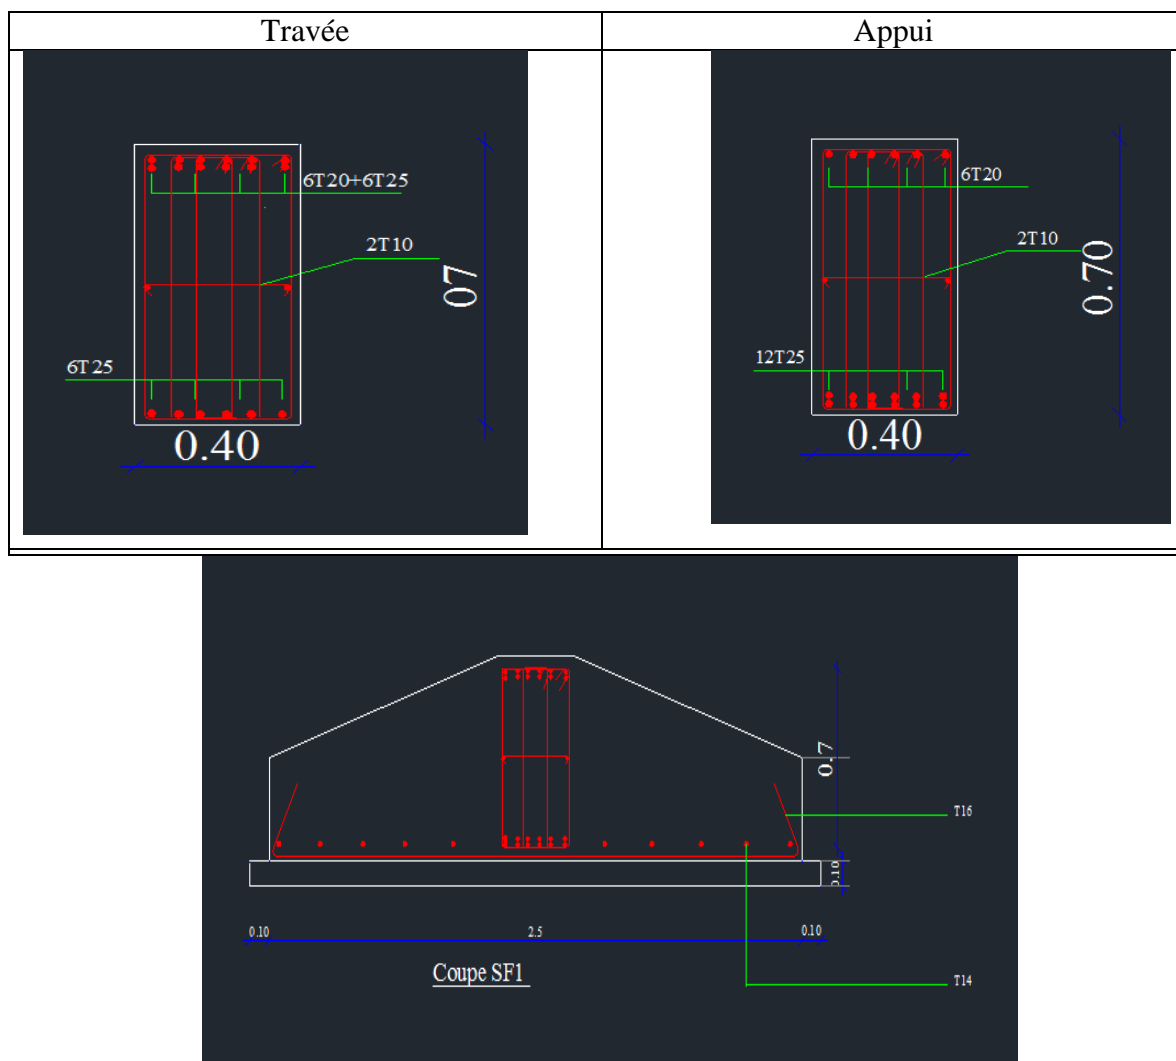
Schémas de ferrailages de la semelle filante.
